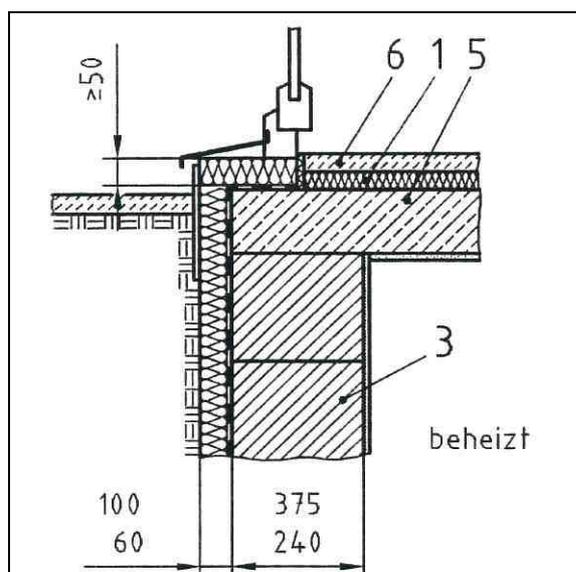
Fenstertür, außengedämmtes Mauerwerk, Anschluss Terrasse
